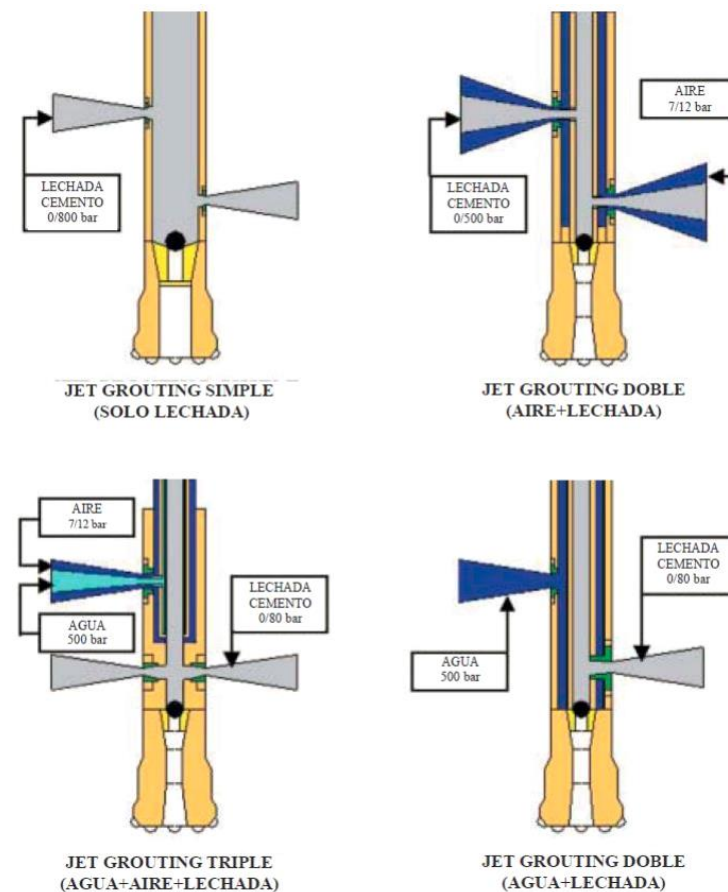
Tipo de Jet-grouting en función de los componentes inyectados.
